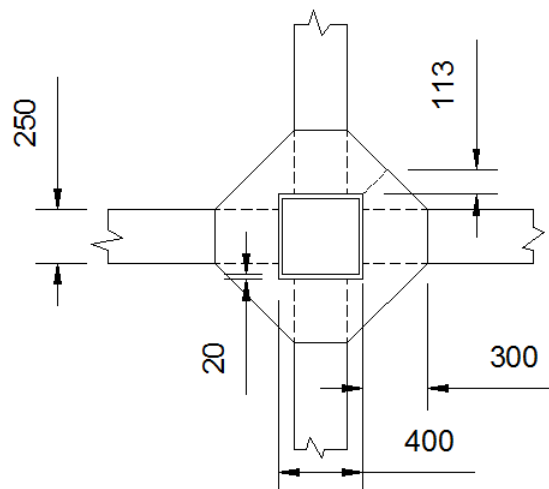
Vista en planta de la conexión viga I-columna tubular rectangular compuesta con diafragma externo. (Dimensiones en *mm*)
